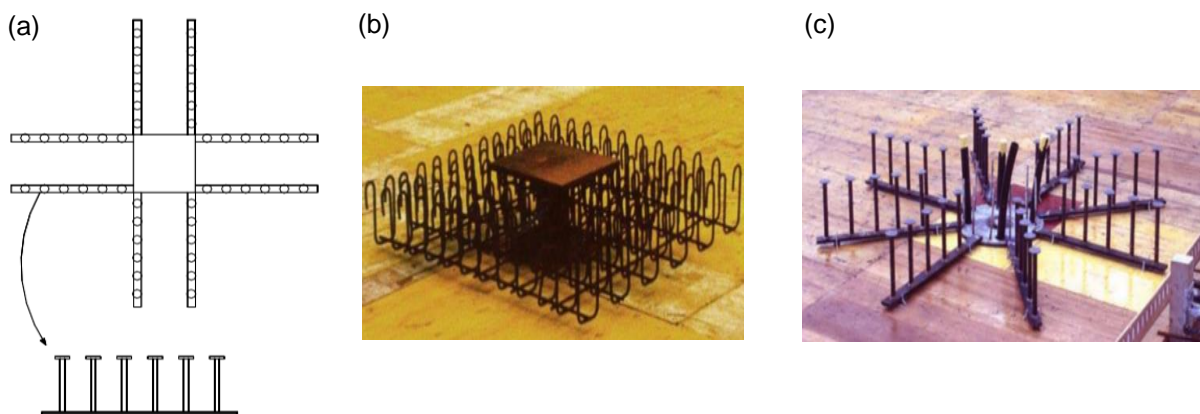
Detalhes das disposições construtivas da armadura transversal: (a) Disposição em cruz de parafusos; (b) Disposição em caixa de estribos de múltiplos ramos; (c) Disposição radial de parafusos (adaptado de [30] e [10])
